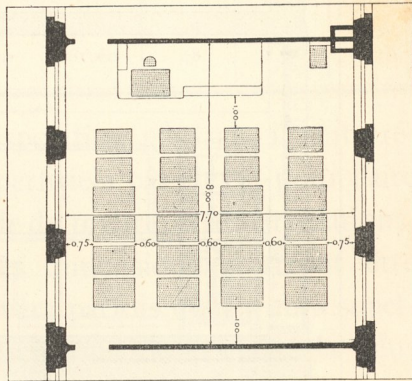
Plan d'une classe à éclairage bilatéral.
